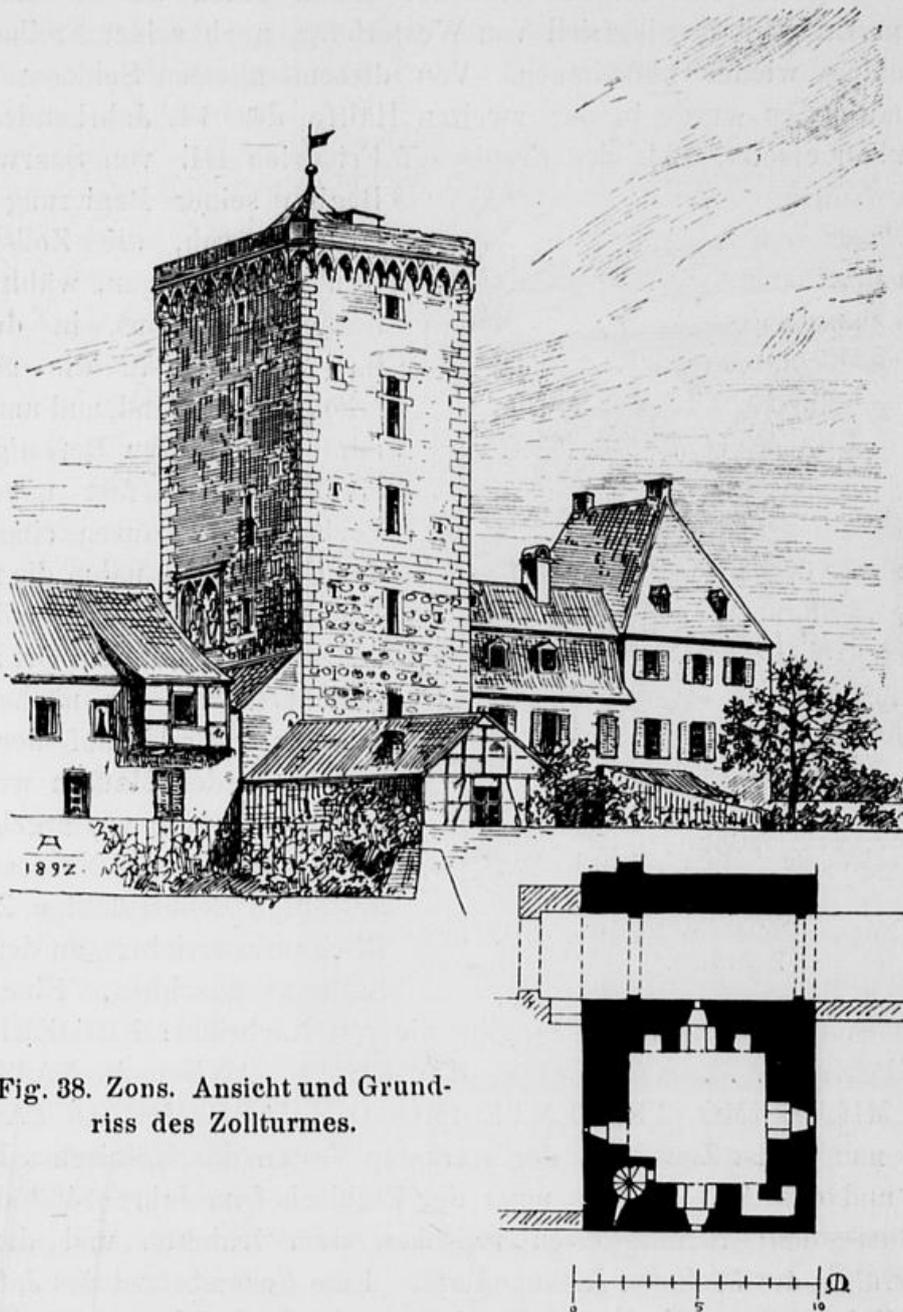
Zons. Ansicht und Grundriss des Zollturmes.
